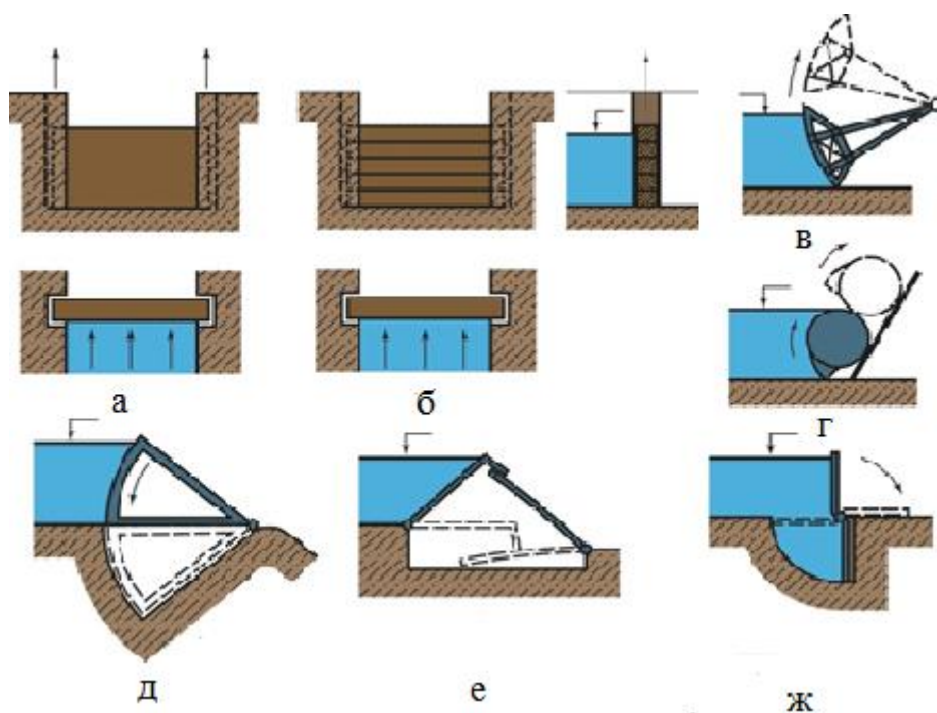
Основные типы поверхностных затворов: а – плоский; б – шандорный; в – сегментный; г – вальцовый; д – секторный; е – крышевидный; ж – клапанный
